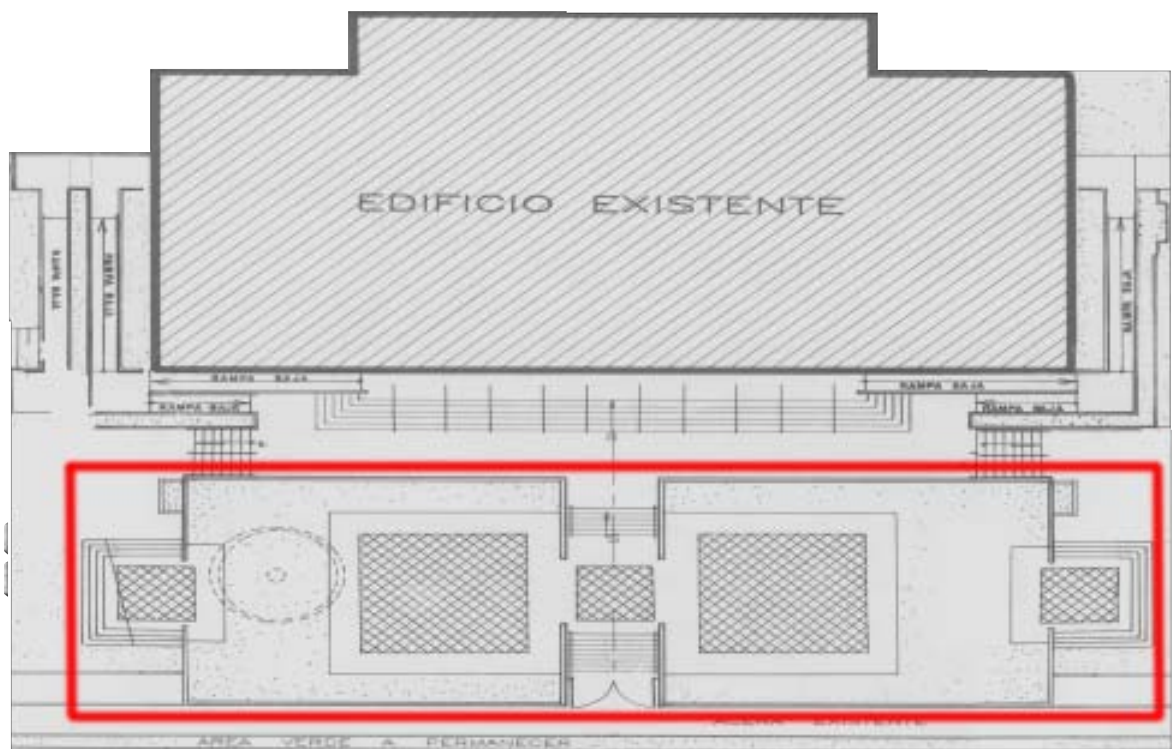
Plano estructural de la Plaza Sur, espacio exterior del CIMHA.
